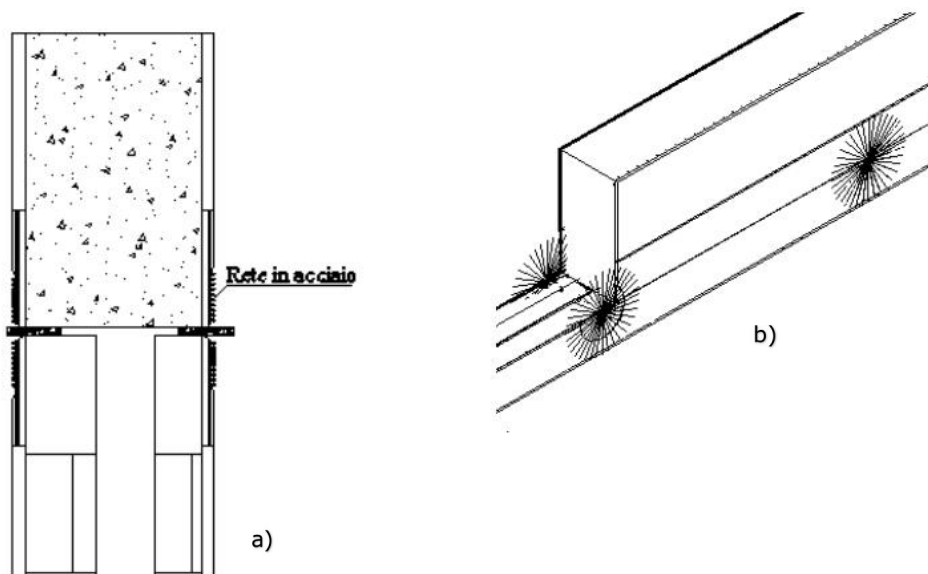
Vista in sezione prima dell'applicazione del fazzoletto in tessuto (a), applicazione del fazzoletto in tessuto unidirezionale in fibre di acciaio (b). Fonte [18].
